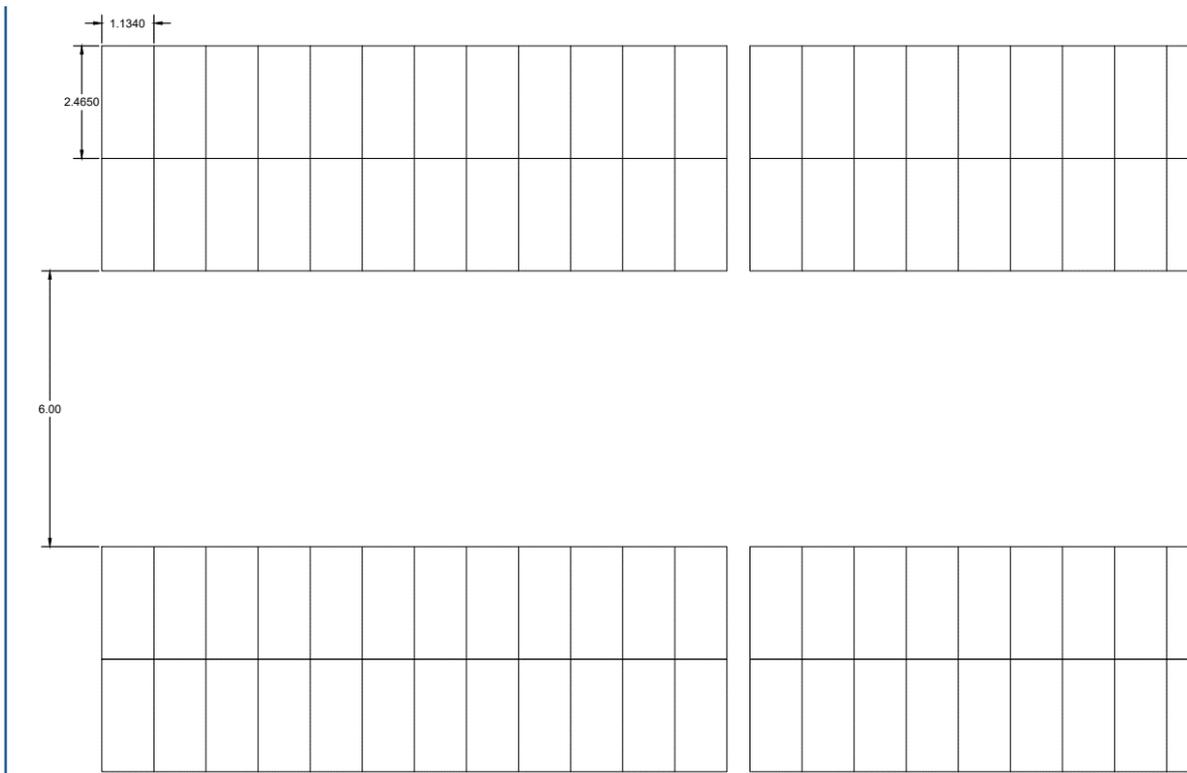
Sezione trasversale e longitudinale dello schema di impianto (strutture fisse)
